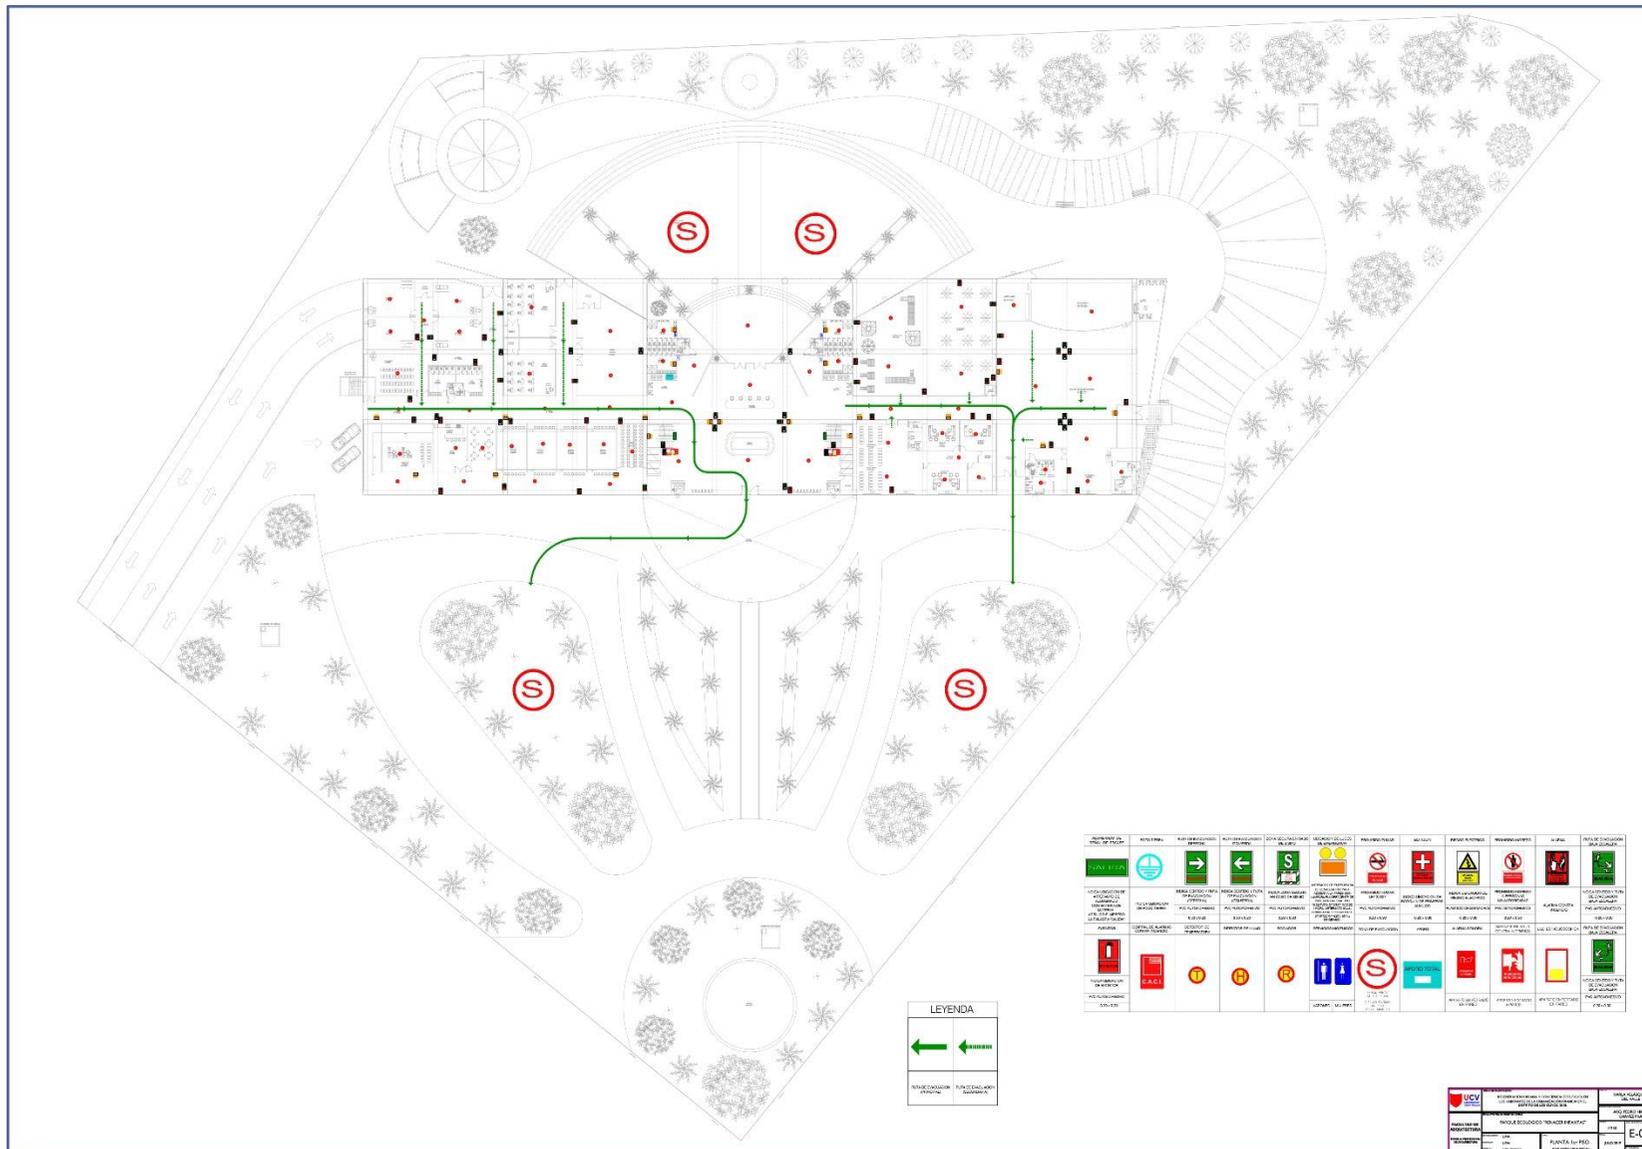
Plano INDECI Planta 1er Piso. Elaboración propia
